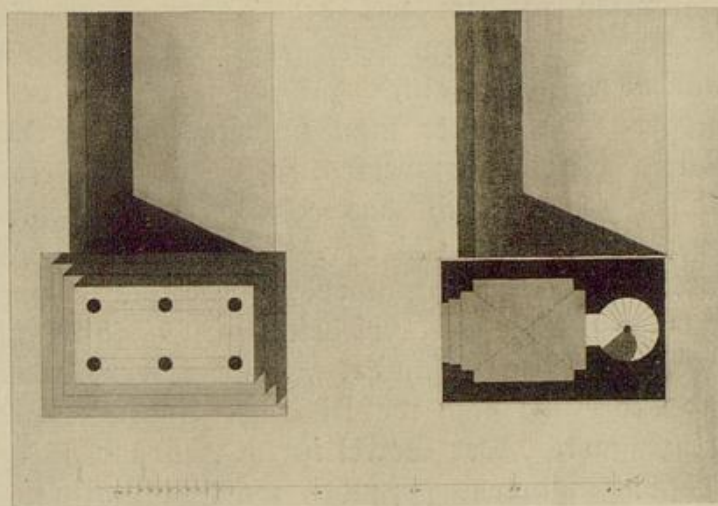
Grundrisse des Vogelhauses im Erbprinzengarten mit Aussicht auf den anschließenden Ahagraben Unbeschrifteter Plan im G.E.N.
